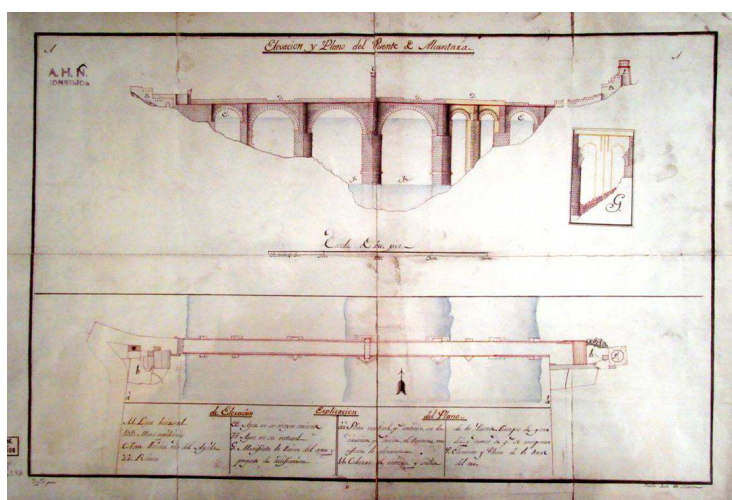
Proyecto de reconstrucción del puente de Alcántara, de Carlos Jeisto y Gundín, 1816, AHN.
